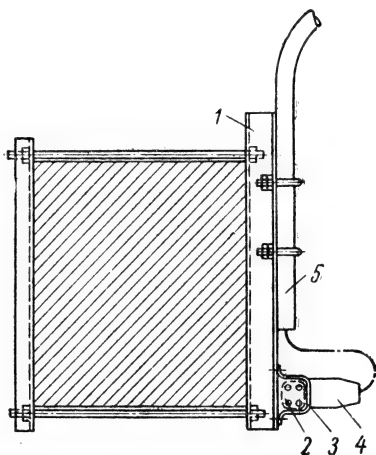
Крепление шинопровода ШОС67 на крепежах вдоль железобетонных ферм и кронштейна для светильника с лампой накаливания.
